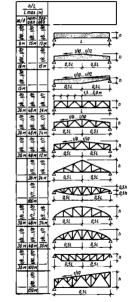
Схемы балок и ферм: L - продет: н - конструктивива высота
